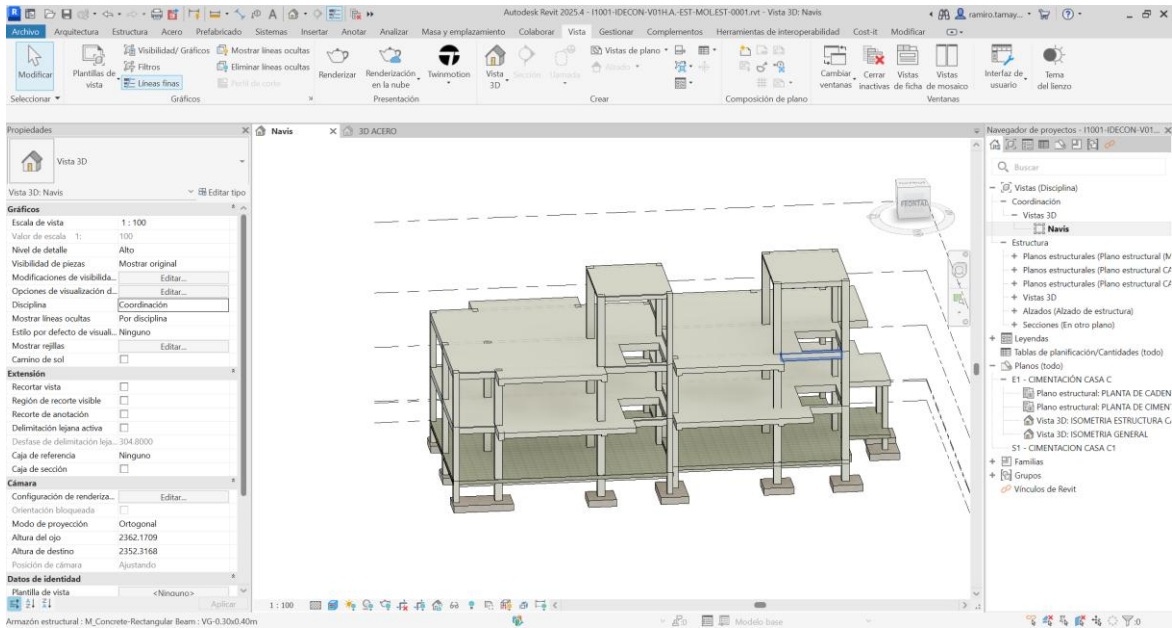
Carpetas por disciplinas en Revit: hormigón armado
